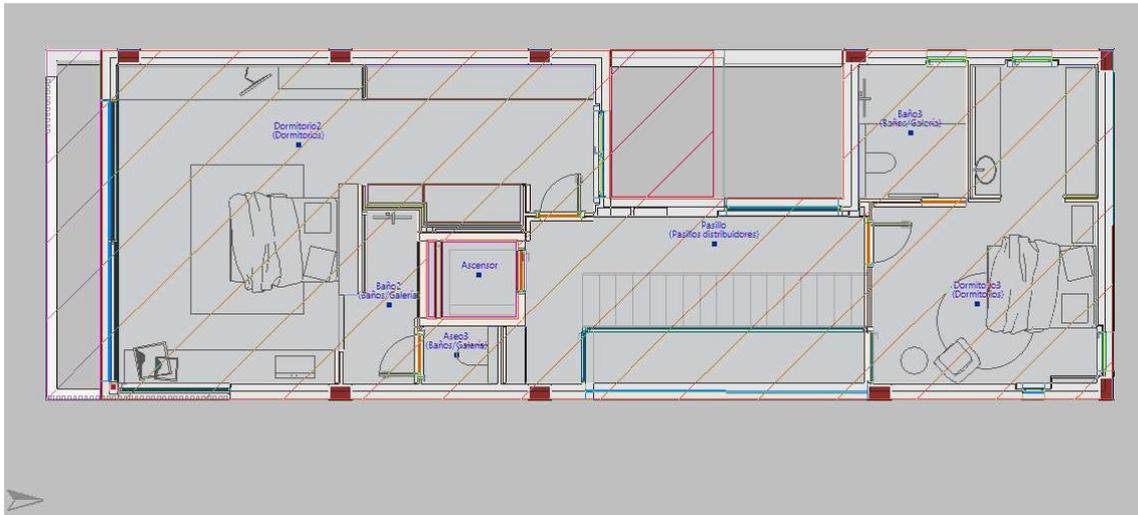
Distribución Planta Segunda. Vista: En Planta. IFC Builder
